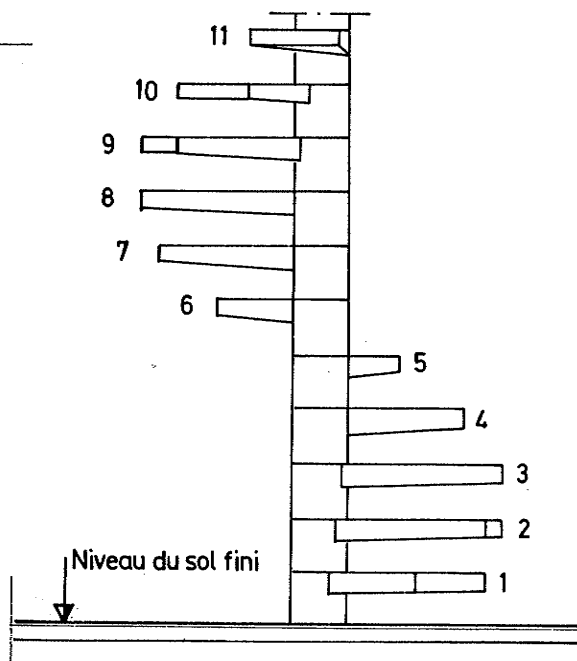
Vue en plan de l'escalier du rez-de-chaussée au niveau supérieur.
